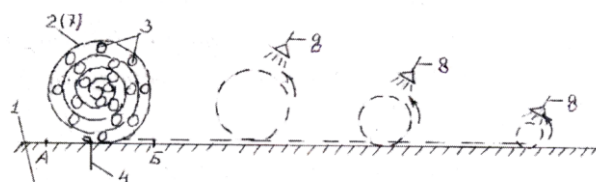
Схема формирования спирального арматурного каркаса с каналами-трубами и полотнищами Concrete Canvas в процессе бетонирования: 1 – основание; 2 – арматурный каркас; 3 – полимерные трубы; 4 – костыль; 5 – полотнище Concrete Canvas; 6 – дождеватель
